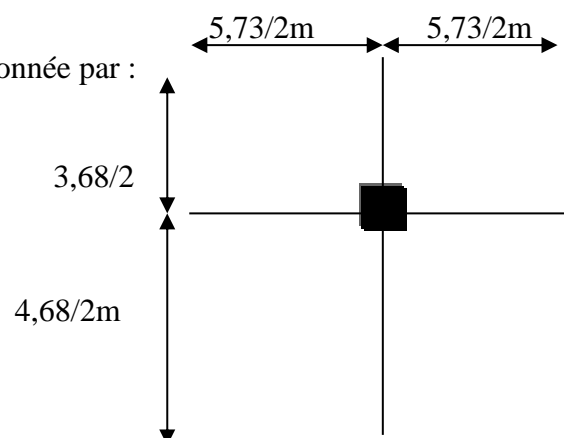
La section la plus sollicitée du poteau rectangulaire.
